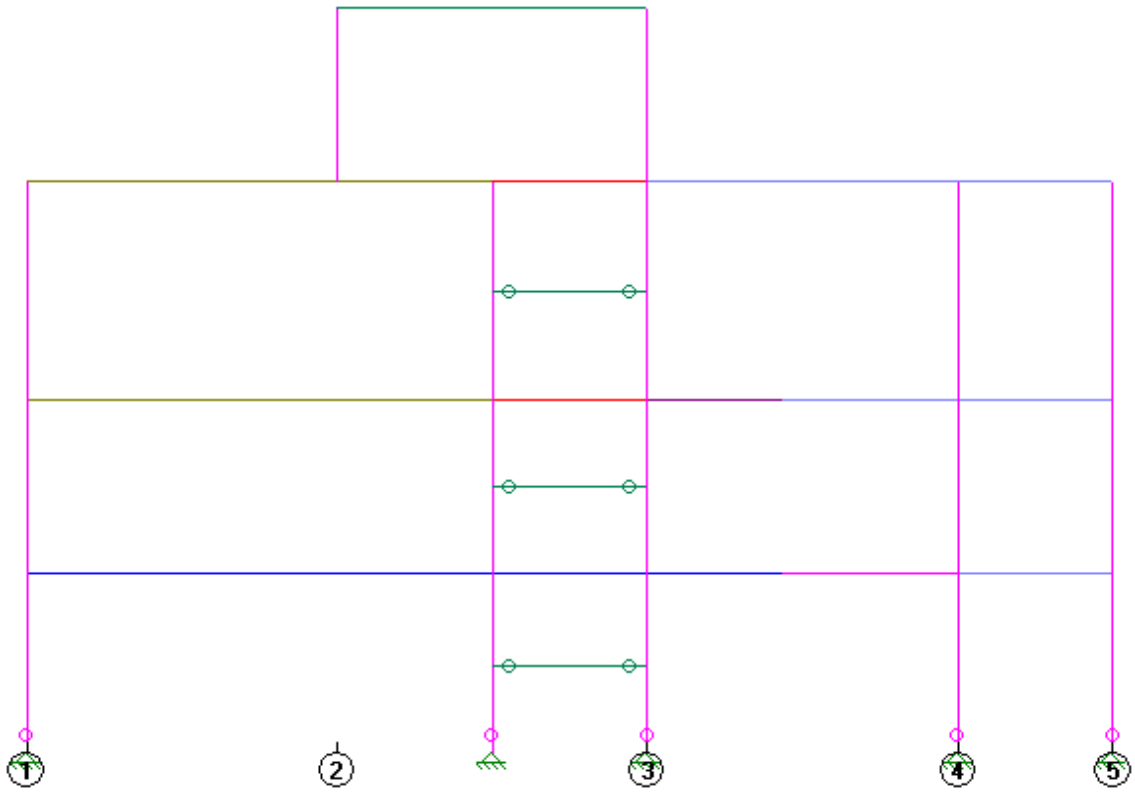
Modelo Estrutural – Elevação do Eixo B
